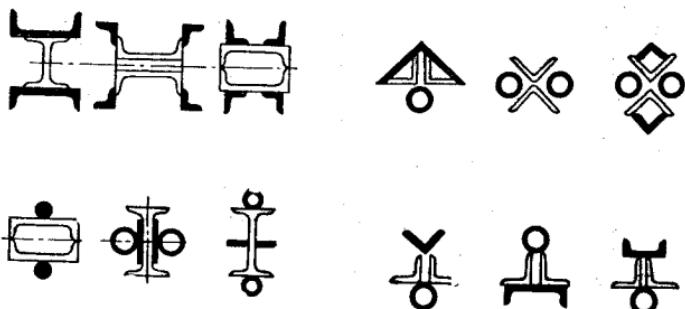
Схемы усиления стоек ненапряженными элементами
